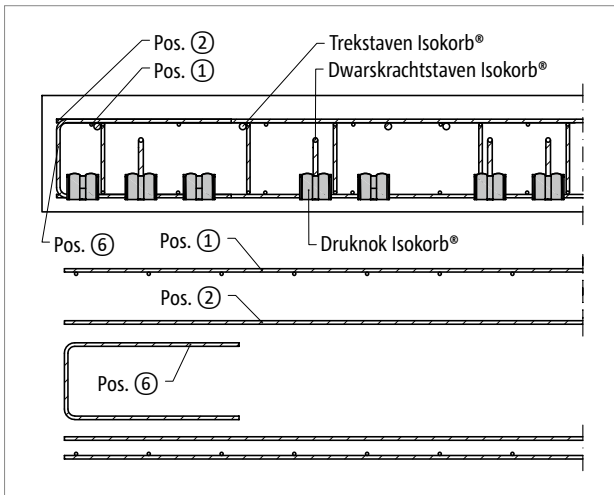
Schöck Isokorb® RT type K: Bijlegwapening bij directe ondersteuning
